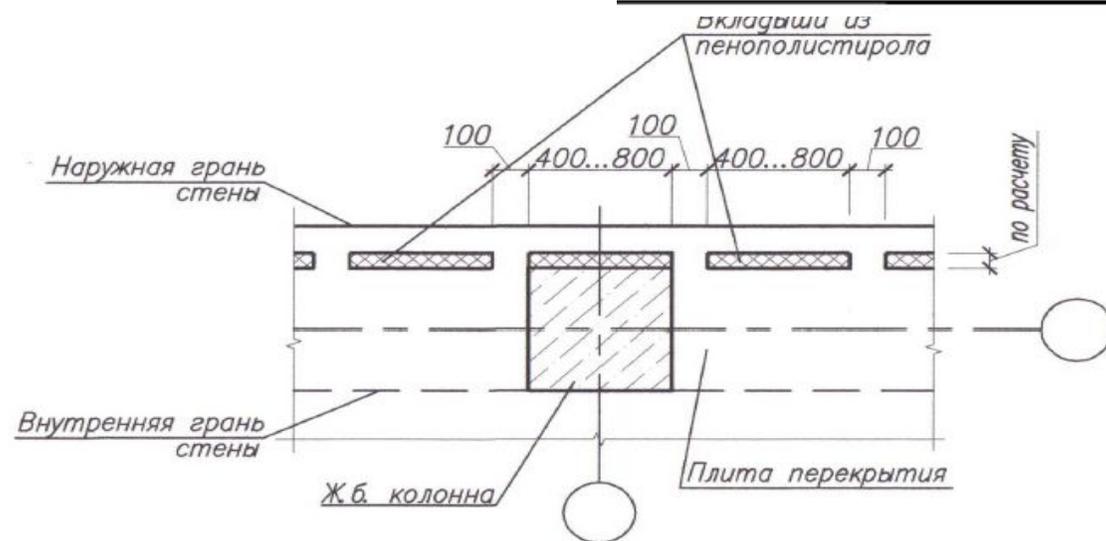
Схема расположения термовкладышей ПЕНОПЛЭКС® в торцевой части монолитной плиты перекрытия.
